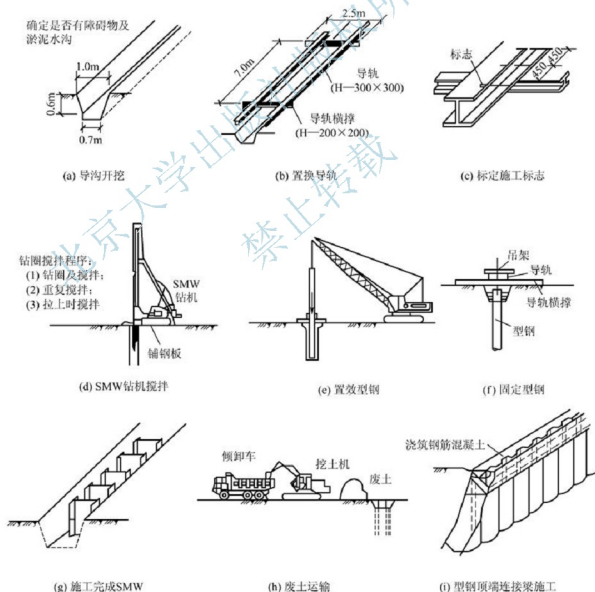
型钢水泥土挡墙施工顺序 (尺寸单位: mm)
